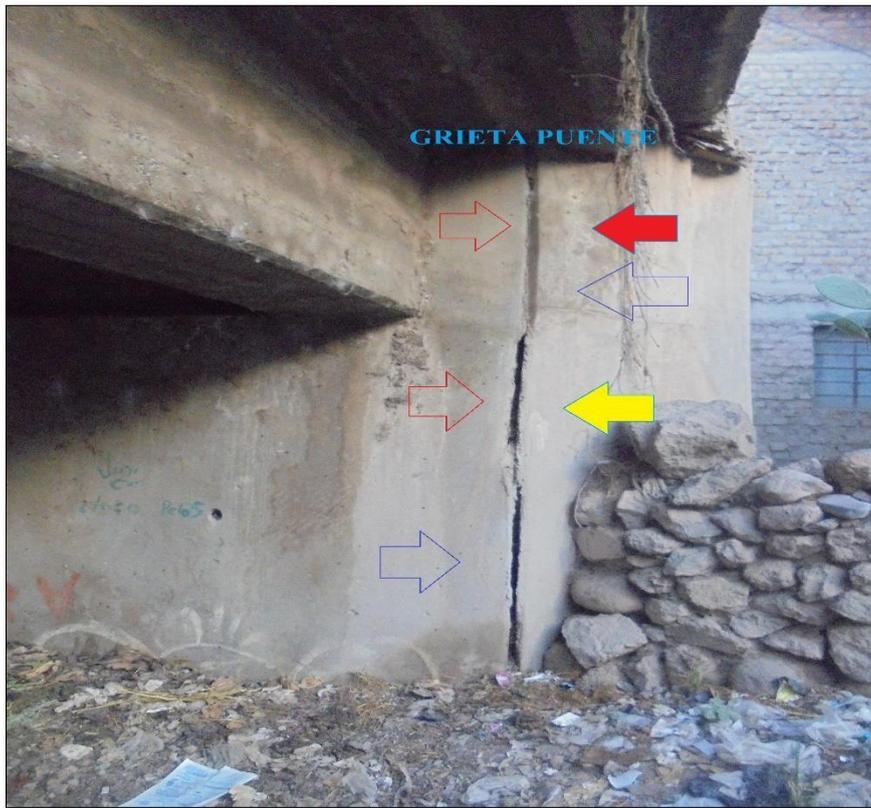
FISURAS EN LA COLUMNA
